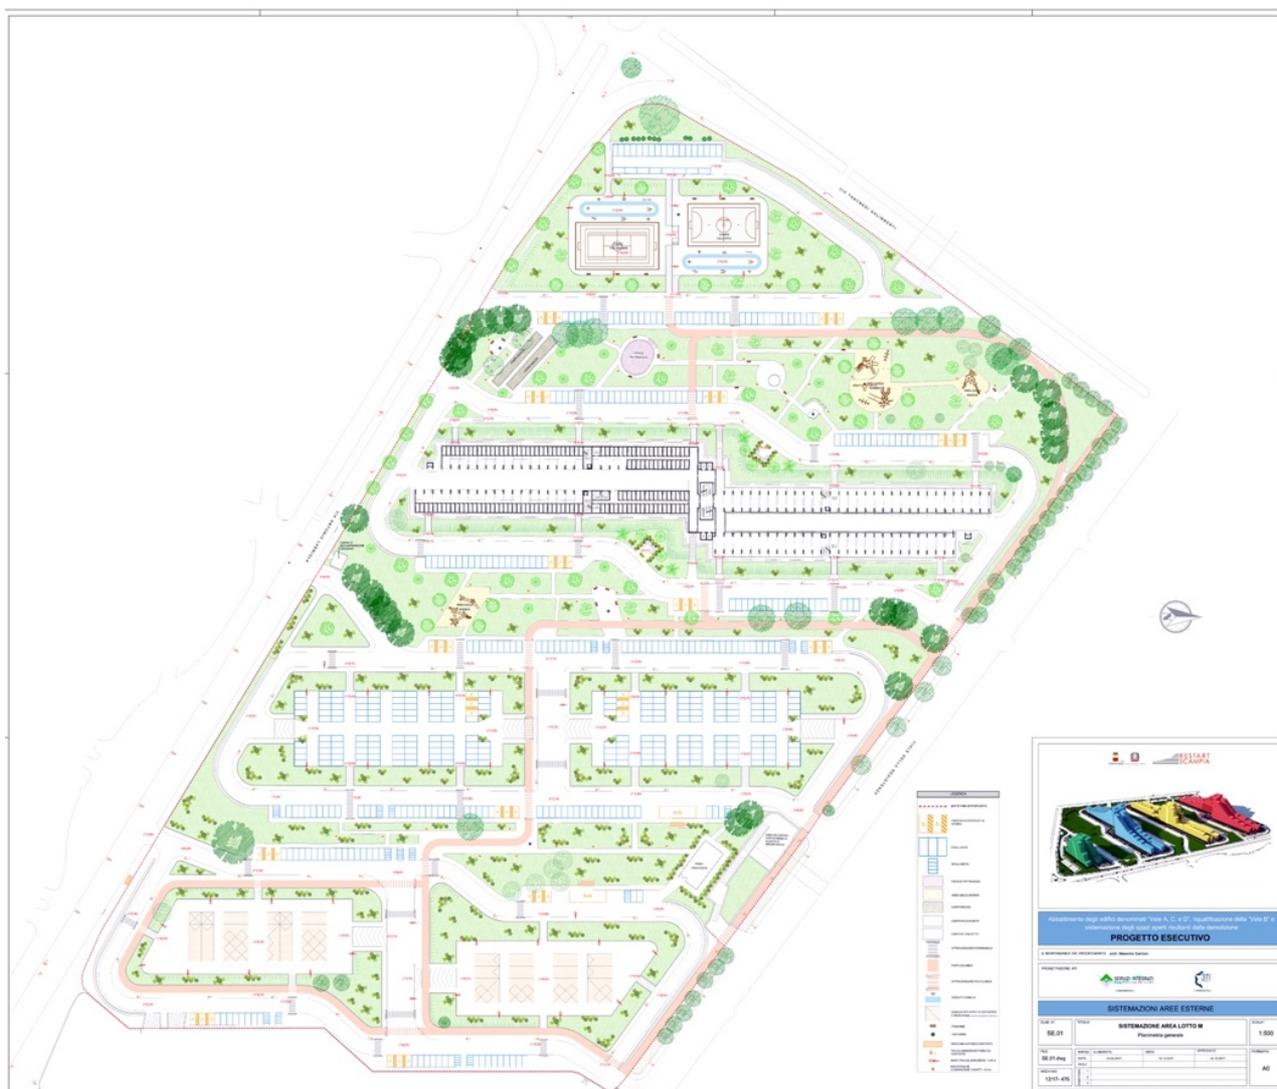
Planimetria di progetto con la Vela B riqualificata e la sistemazione delle aree risultanti dalla demolizione.
